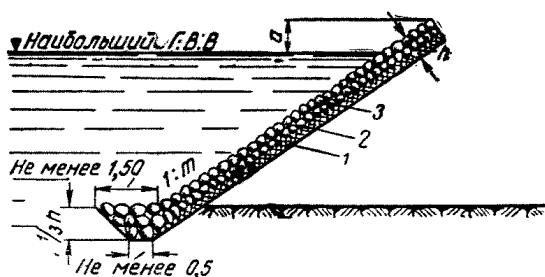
Укрепление откоса насыпи или бермы двойным мощением
